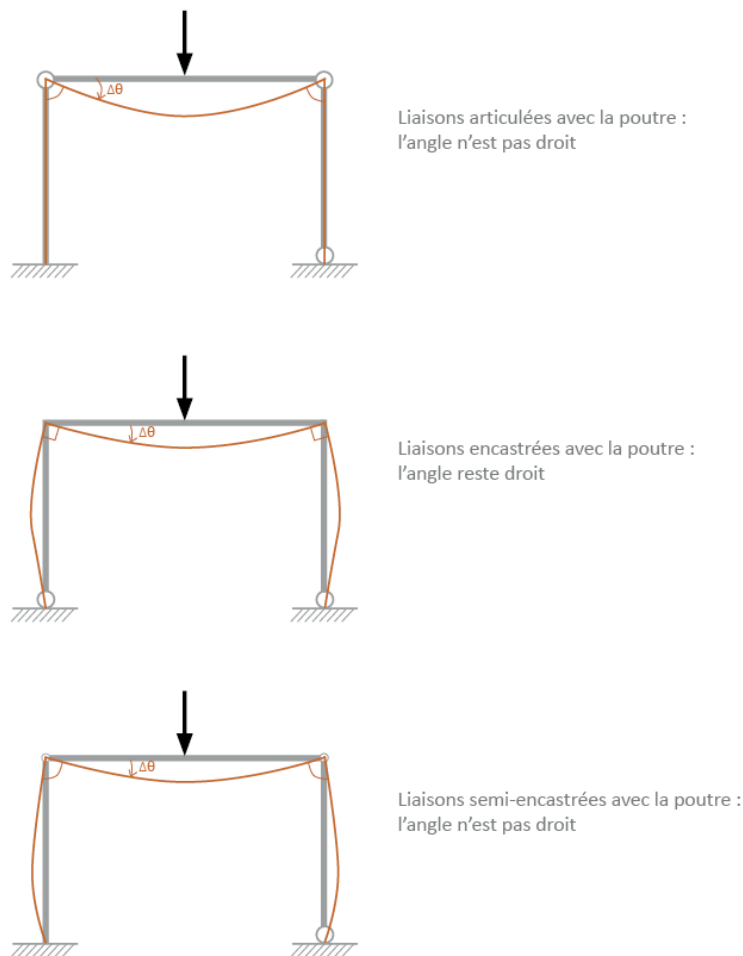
Déformations possibles pour un portique selon le type de liaison entre la poutre et les poteaux.
